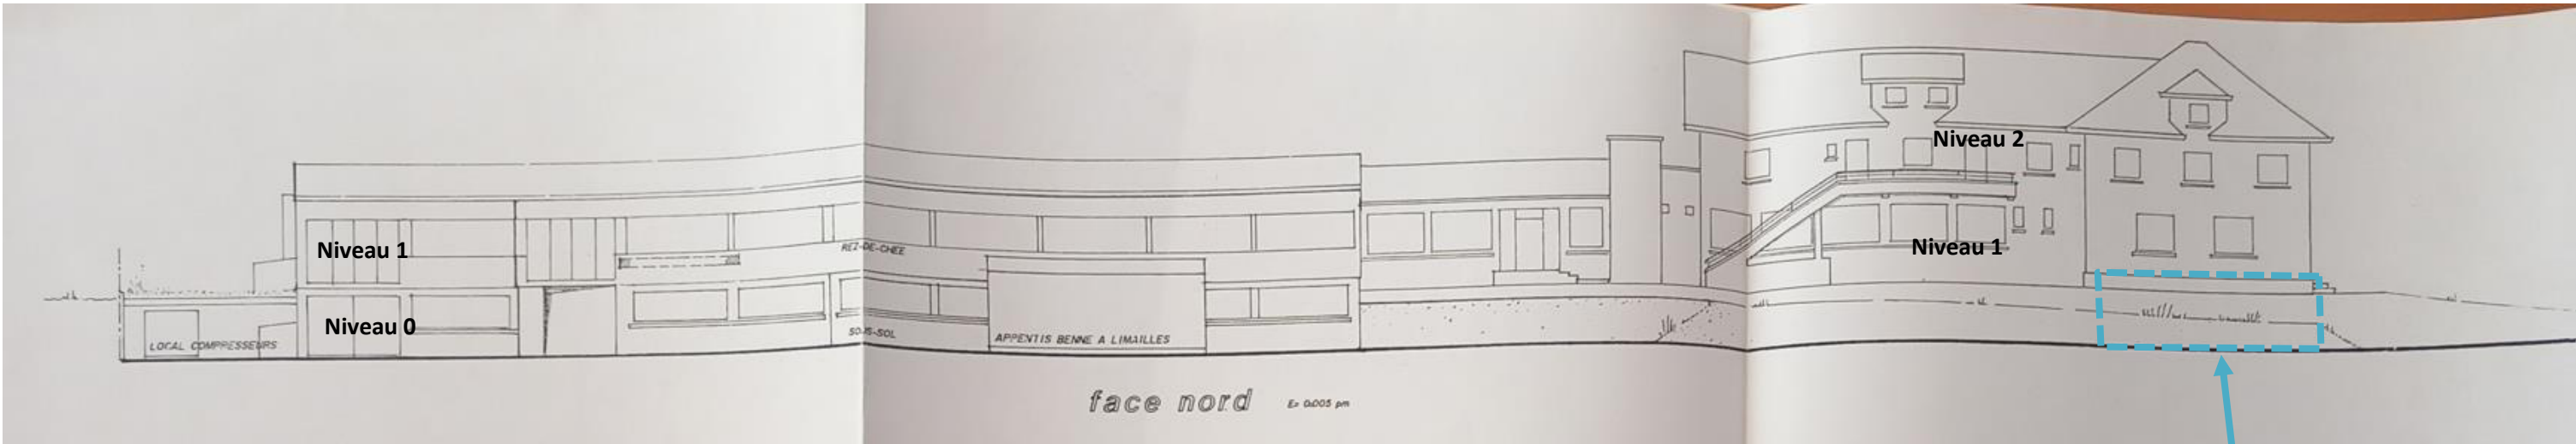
Coupe façade Nord de 1992 du site EBEA (Source : Archives départementales de la Haute-Savoie)
